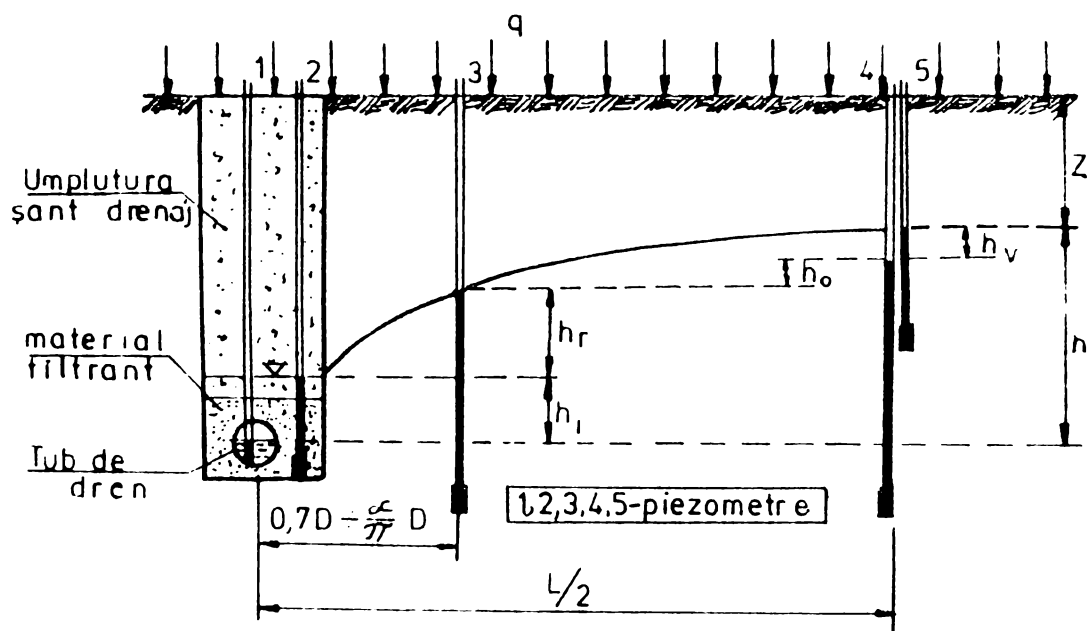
Schema generală a pierderilor de sarcină la drenurile agricole.
